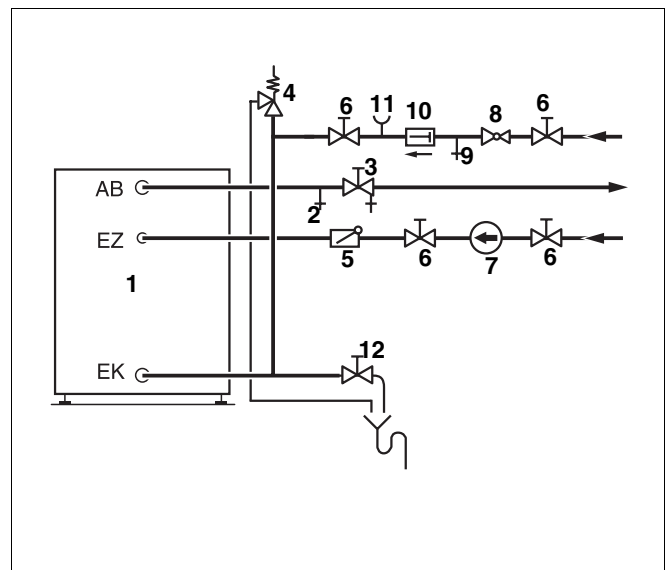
Installation et équipement des conduites d'eau chaude sanitaire
